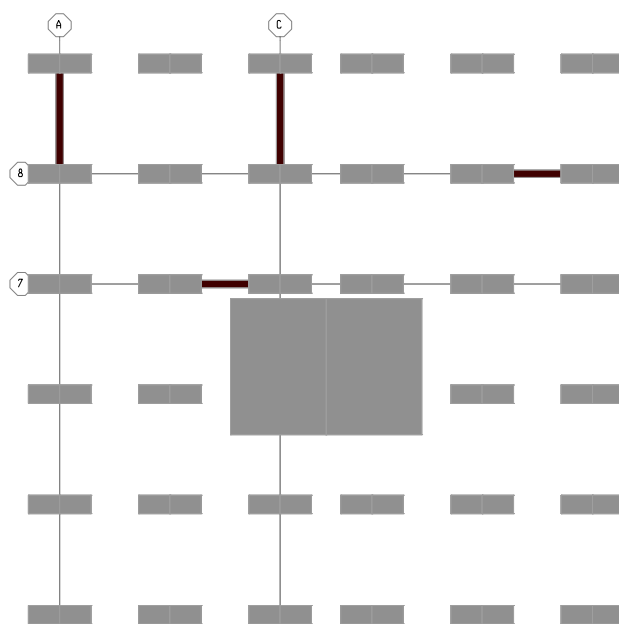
Localização em planta das vigas de fundação analisadas no edifício tipo
